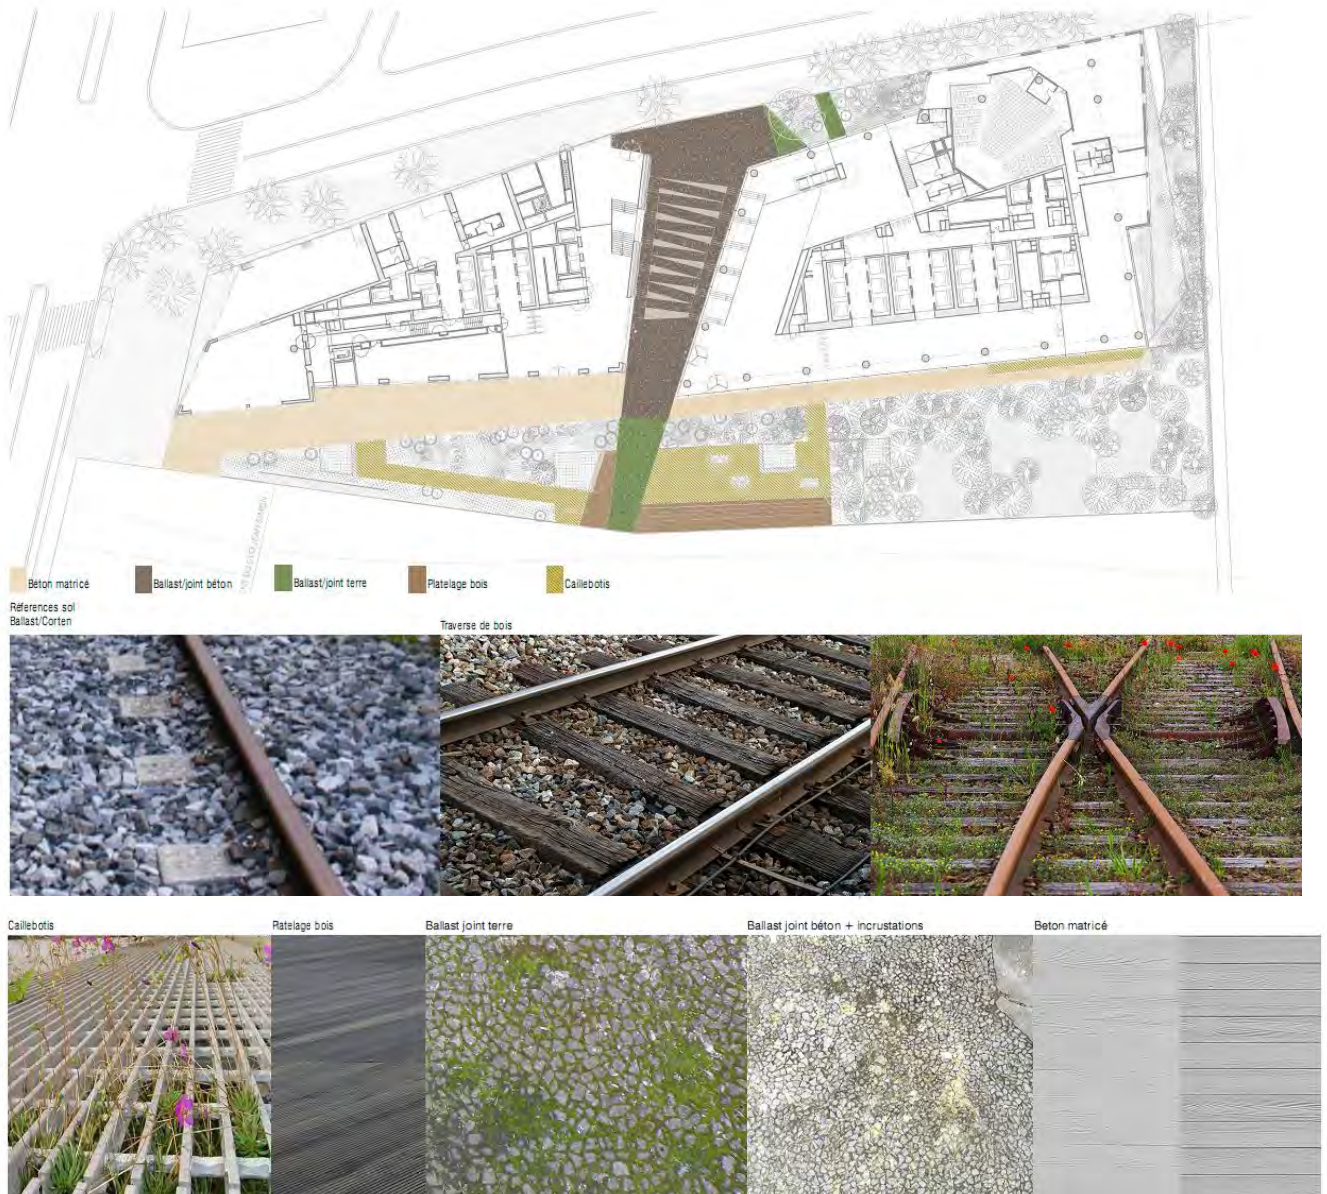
Plan de localisation des sols et détails sur les sols issus du plan masse (février 2014)
